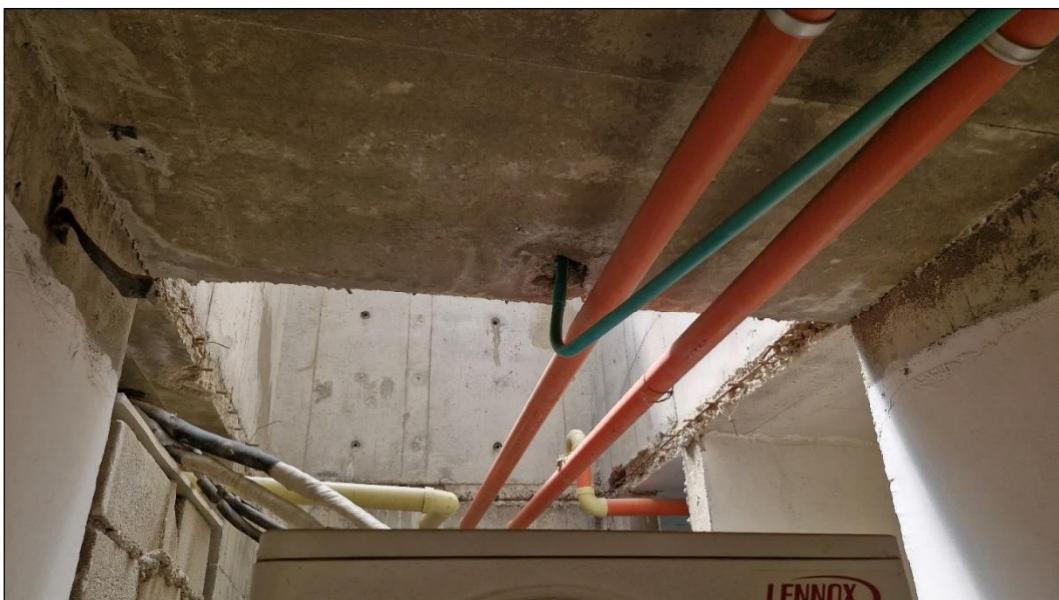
Mallas de acero expuestas. La losa de entrepiso al parecer fue cortada para abrir el ducto dejando a la vista el acero de refuerzo.
